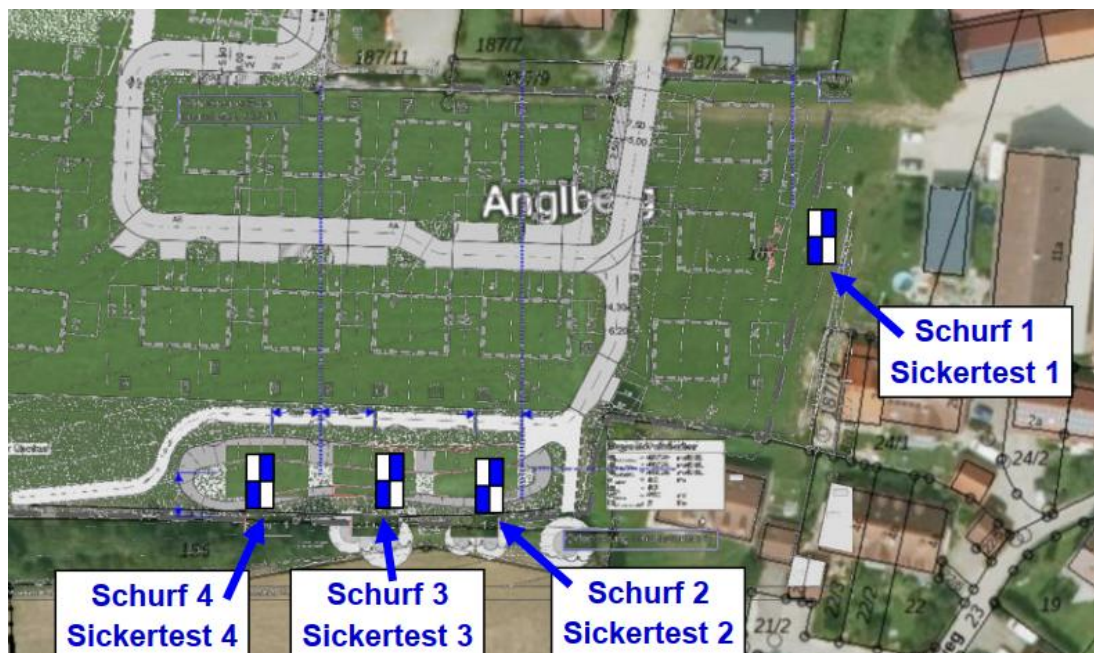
Lageplan Baggerschürfe und Sickerversuche
